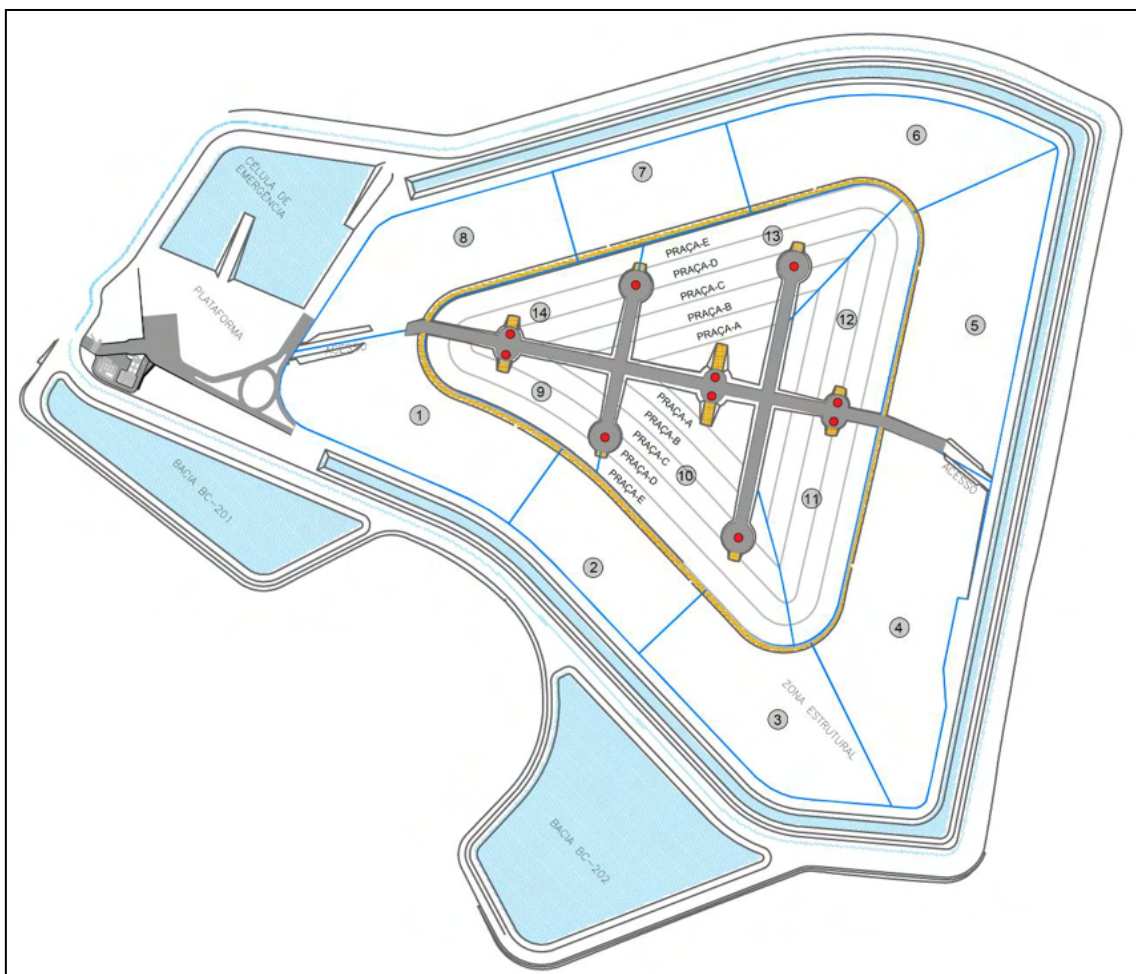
Setorização da Zona Estrutural em faixas e praças.
